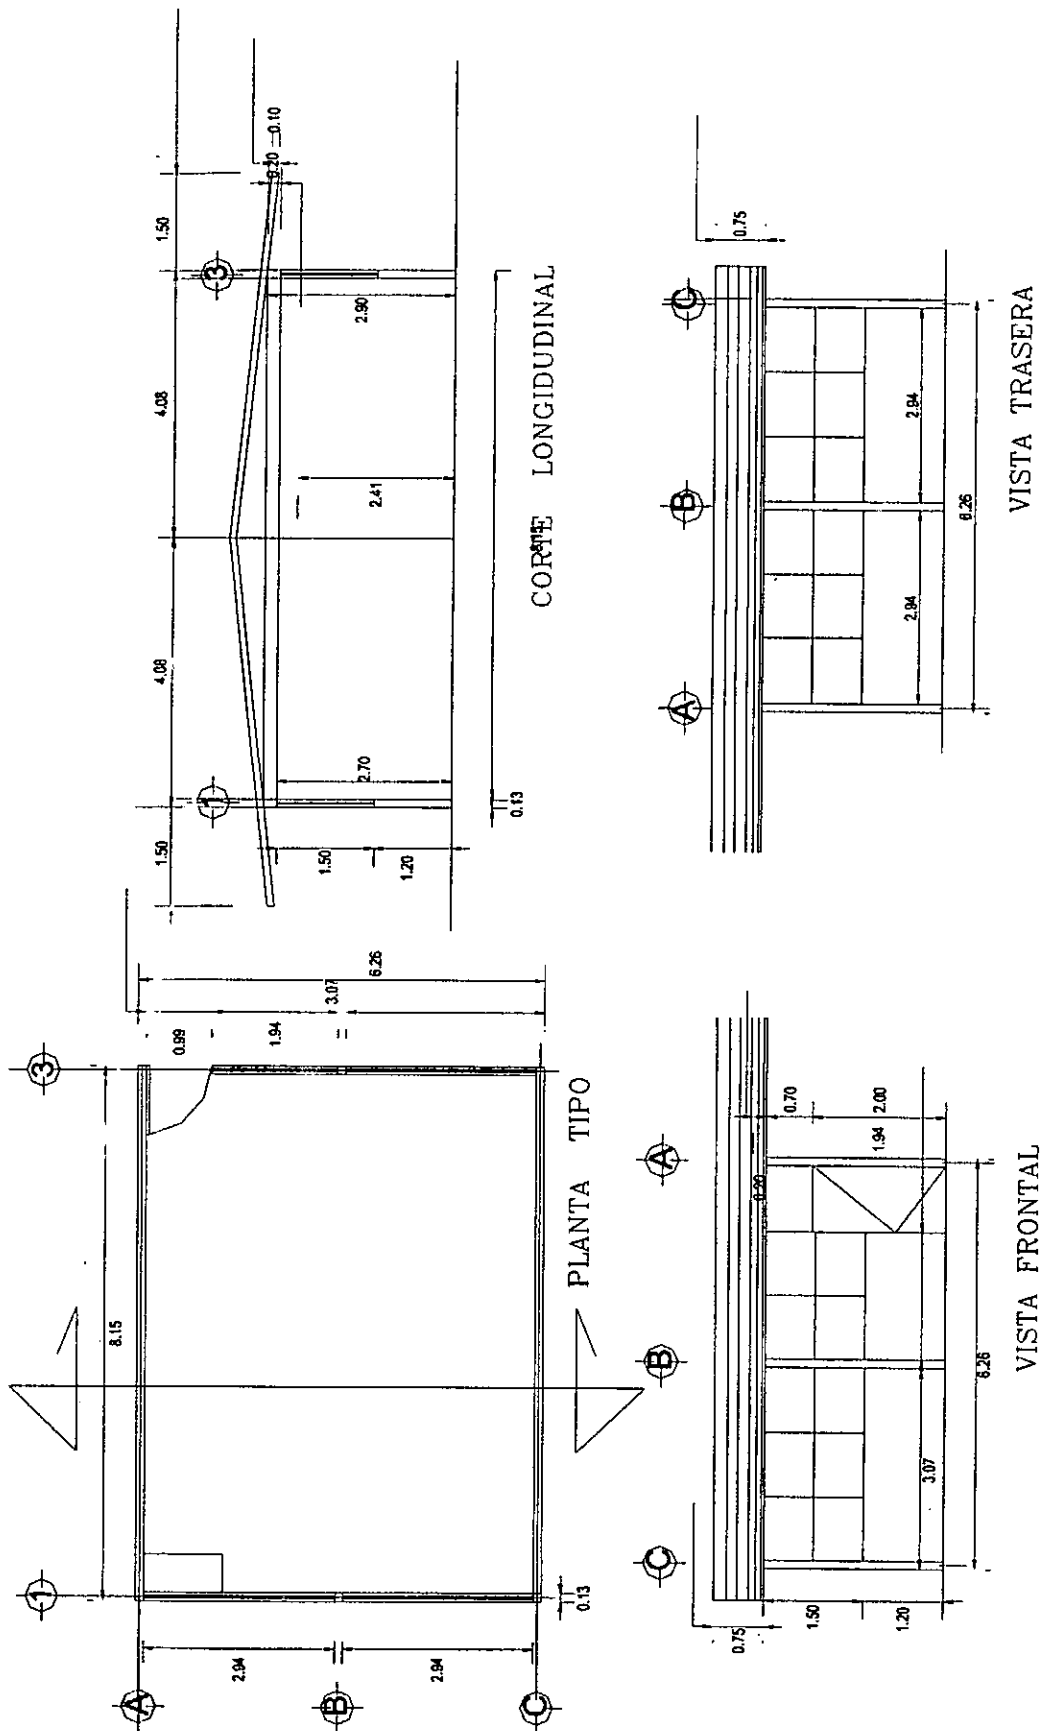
Planta y alzado tipo de escuela Alfredo V. Bonfil
